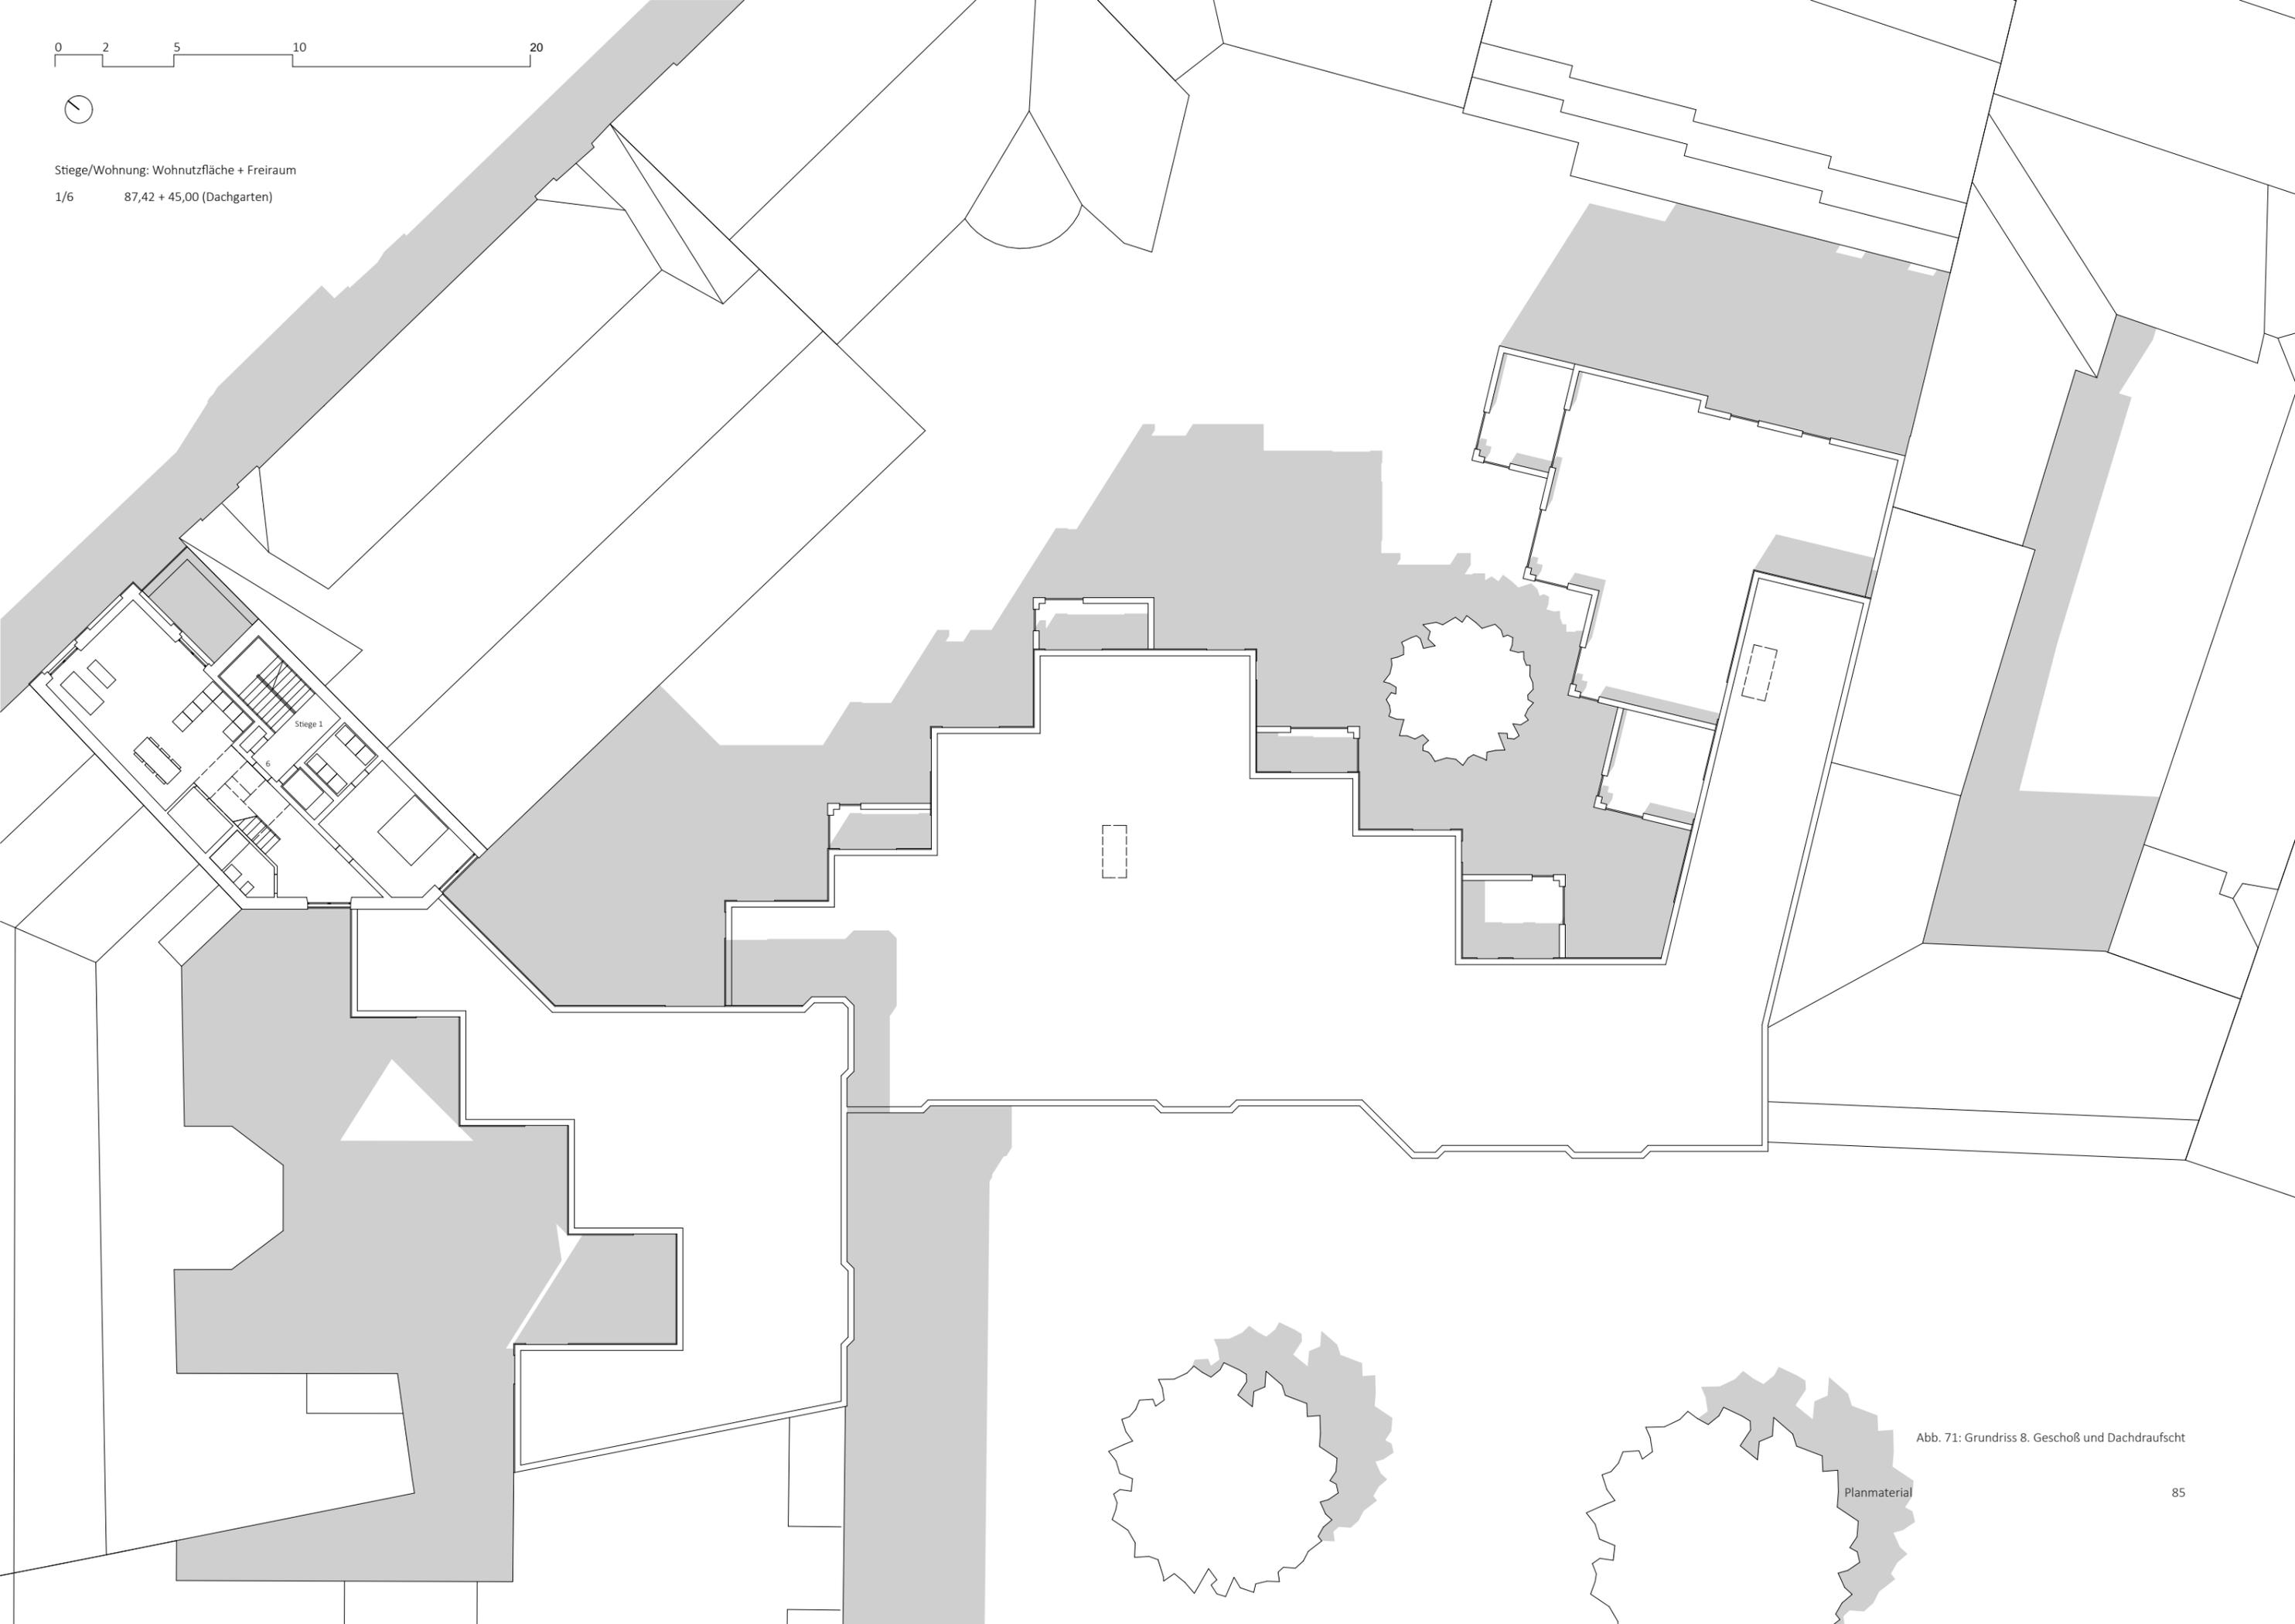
Grundriss 8. Geschoß und Dachdraufsch
